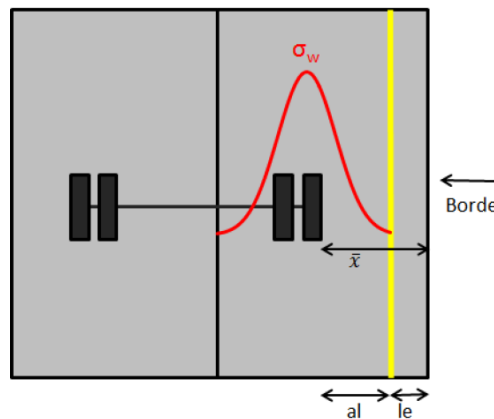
Distribución Lateral Típica de un Pavimento de Concreto
